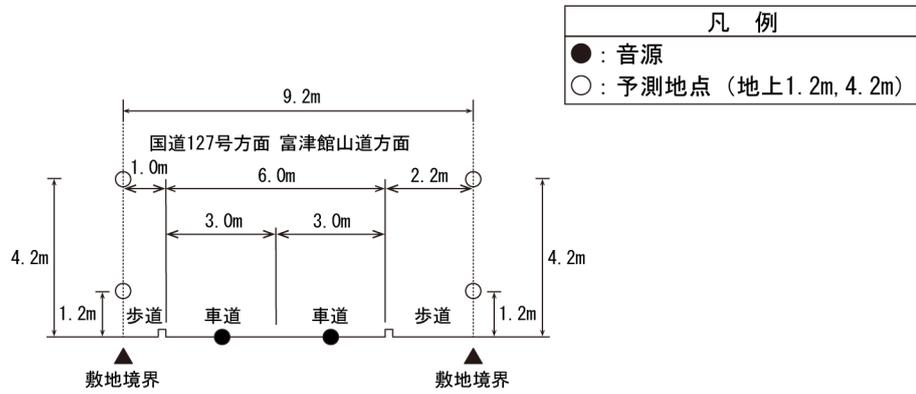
(1) 予測断面図 (A. 県道 258 号富山丸山線)
